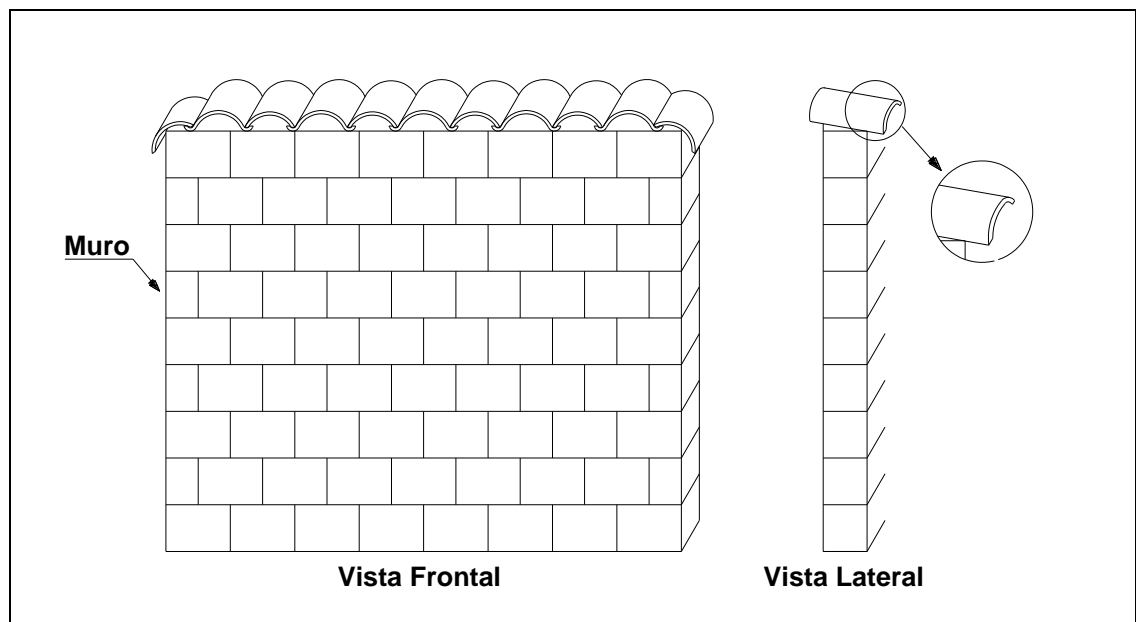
Detalhe construtivo dos muros: assentamento de telhas cerâmicas
